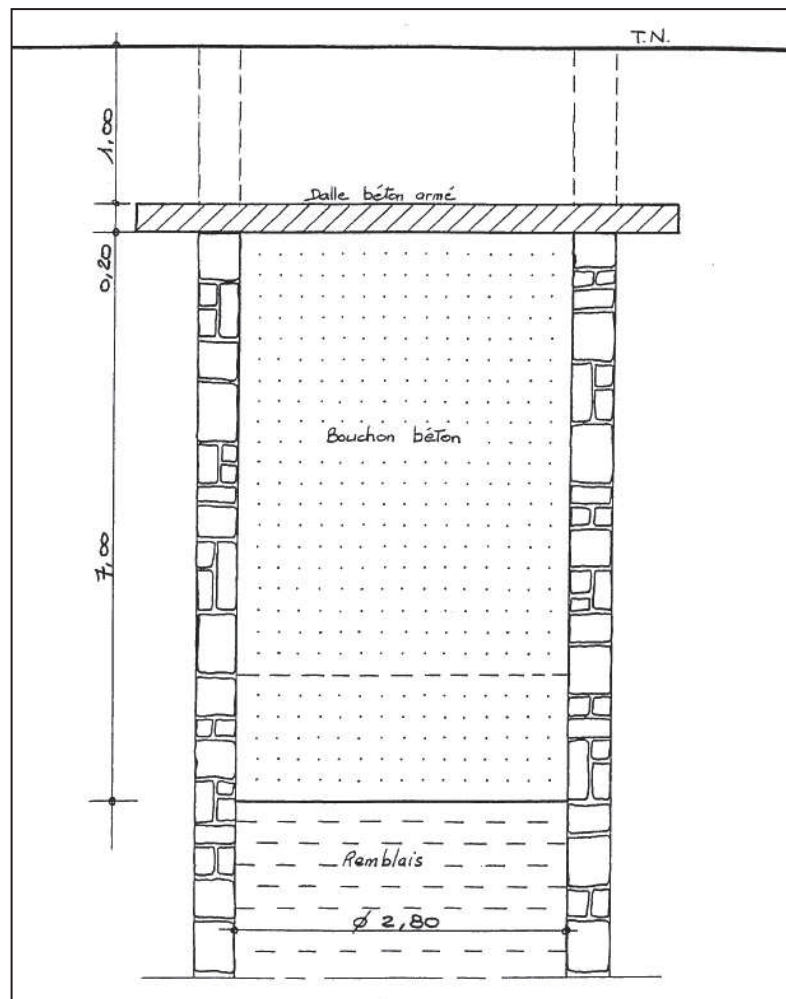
Schéma de mise en place du bouchon béton au puits de Chamblève
